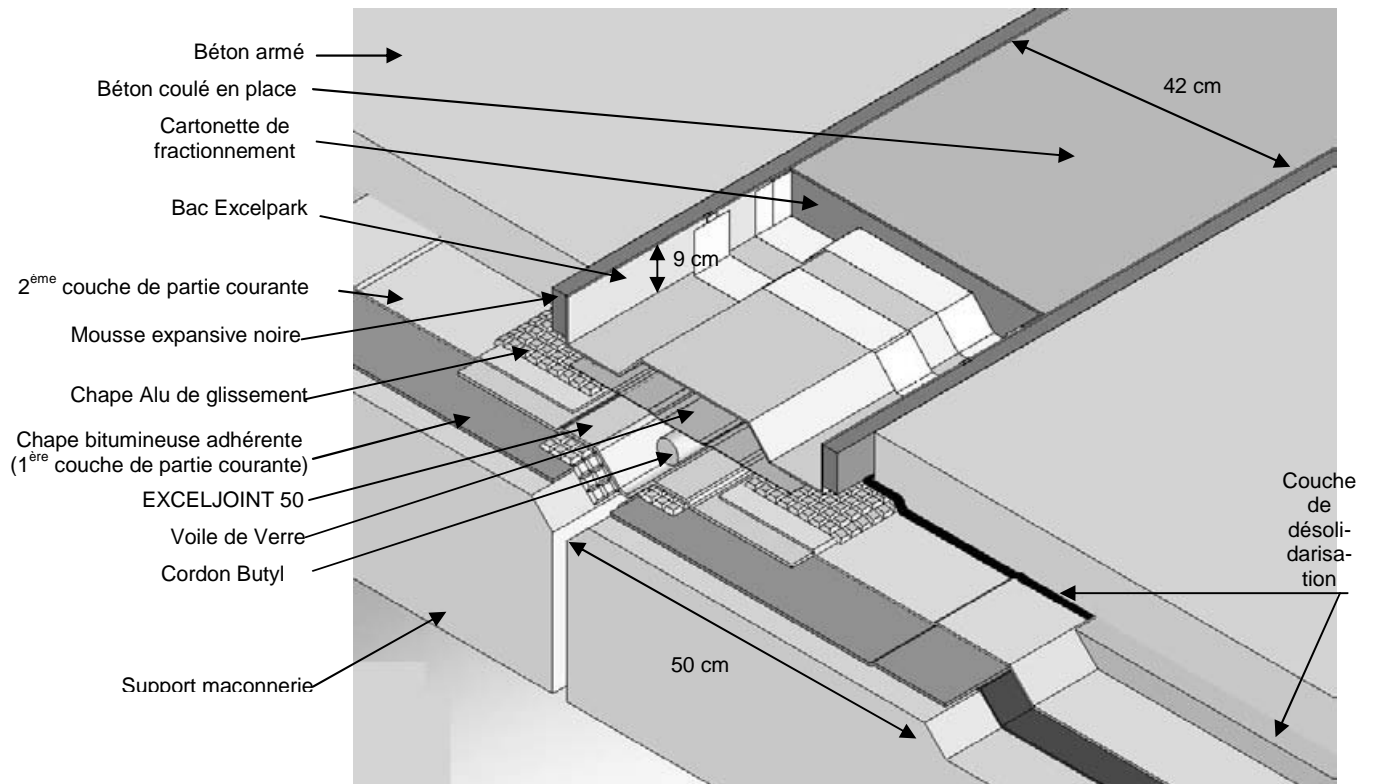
EXCELPARK 2 Béton : schéma de principe sur support maçonnerie
